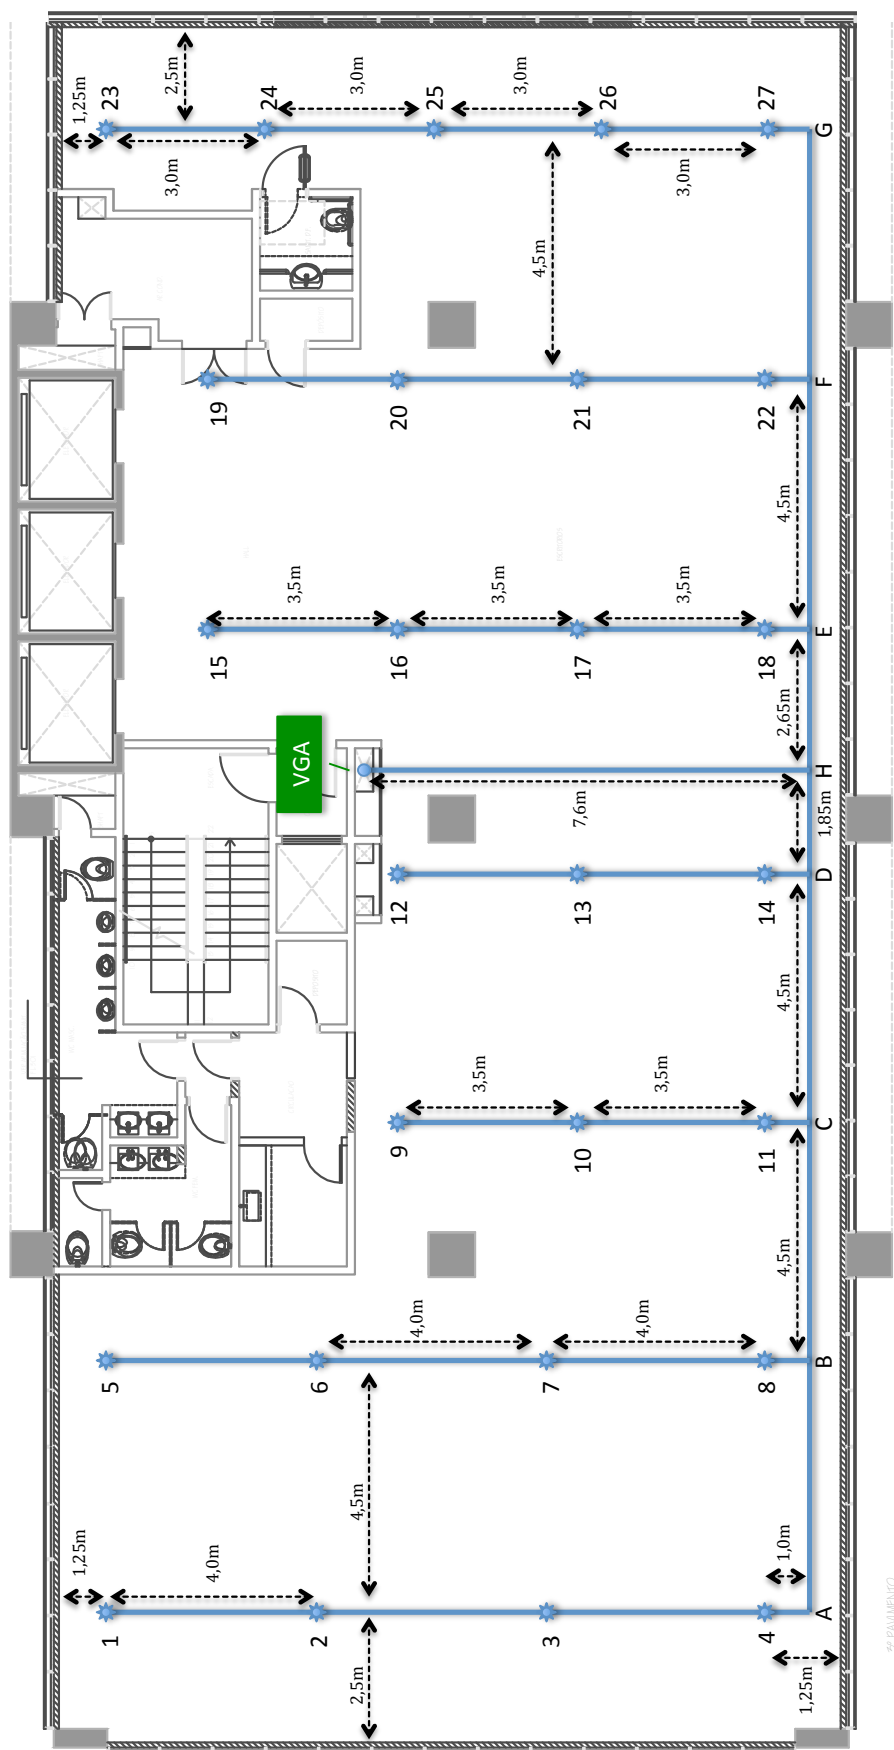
Planta de distribuição de sprinklers dos andares 1 e 2
